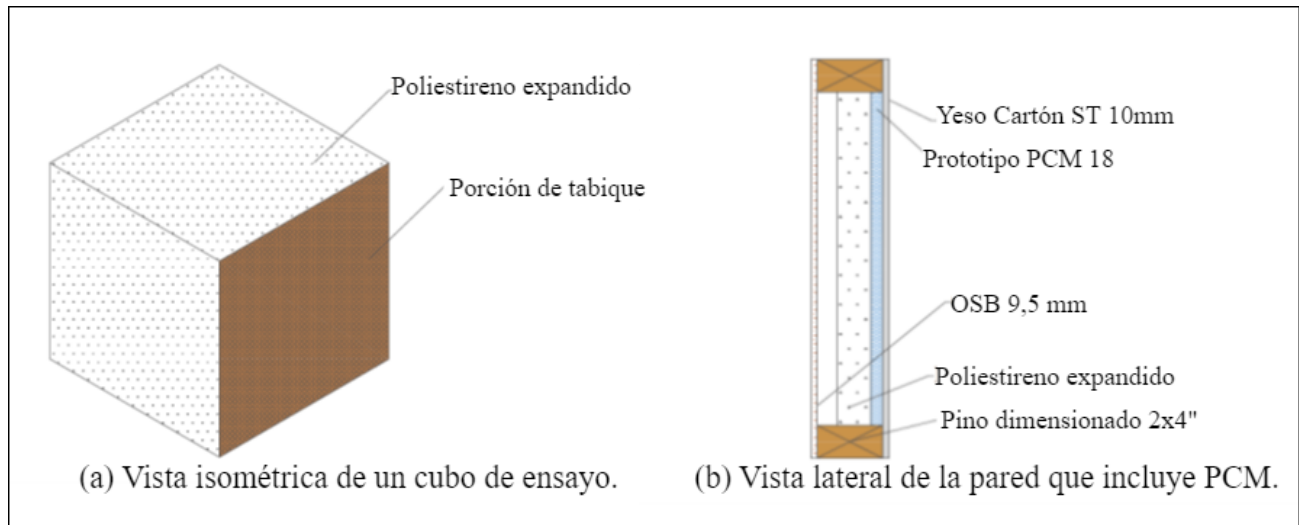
Cubo de ensayo y sistema constructivo 1.2.M.C2.4. Fuente: Elaboración propia.
